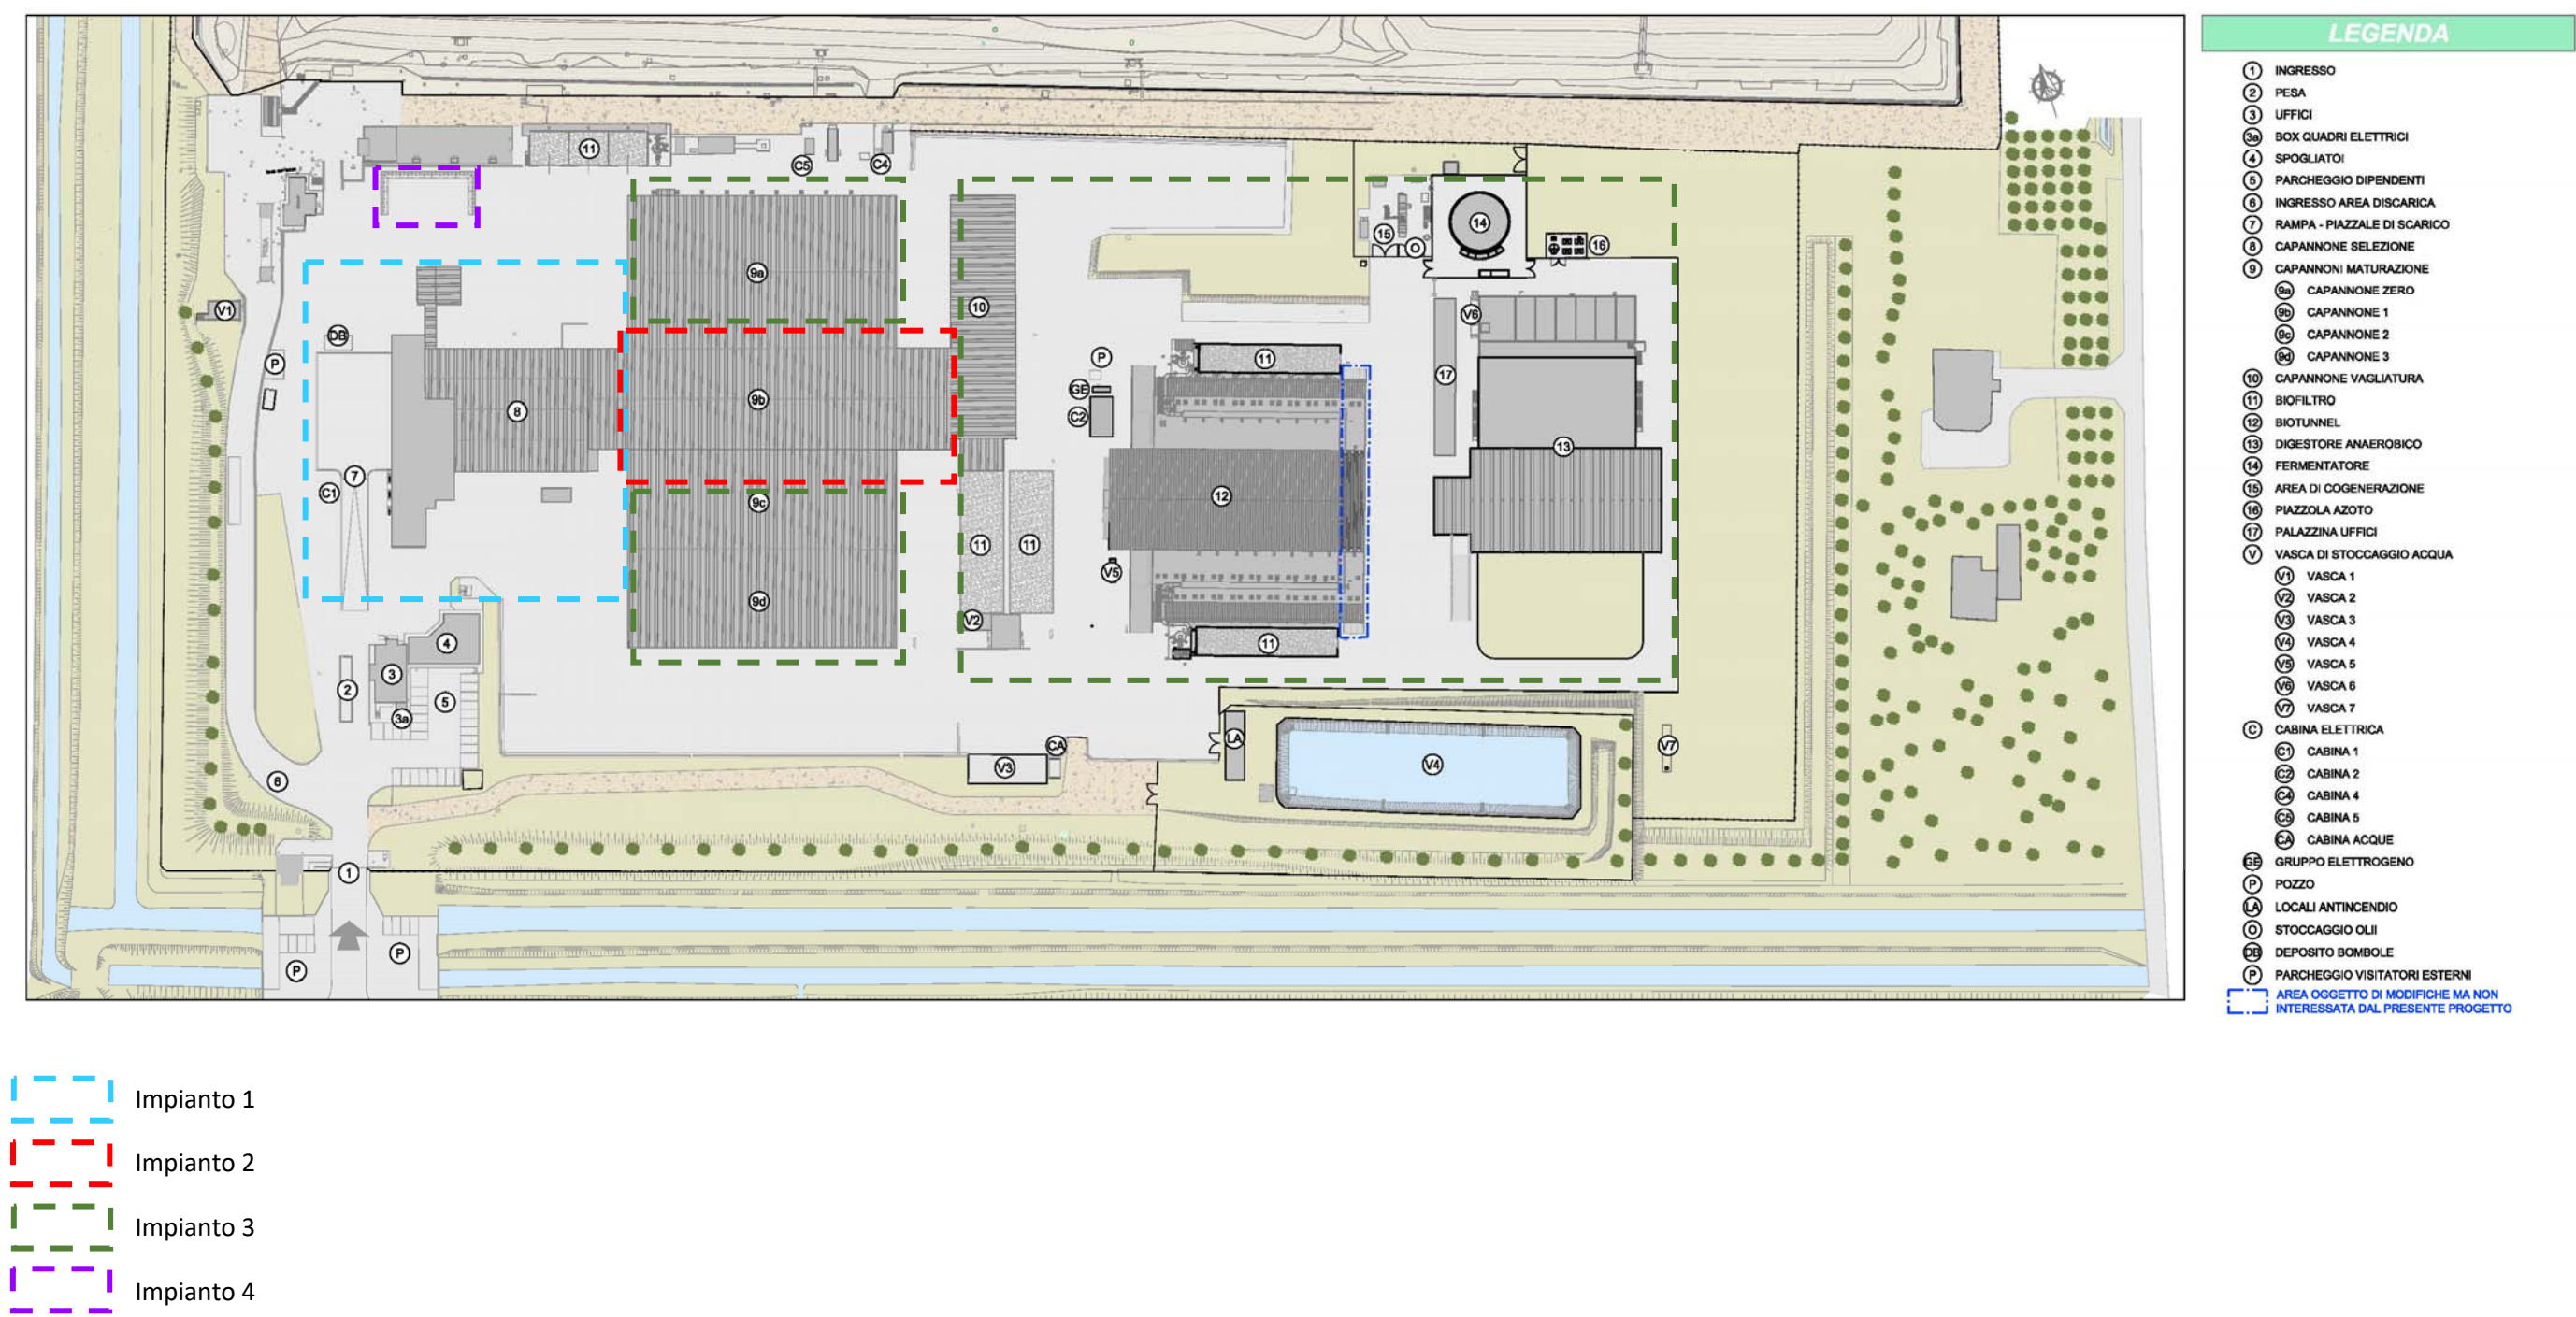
Planimetria dello stato di fatto con indicazione delle diverse sezioni impiantistiche
